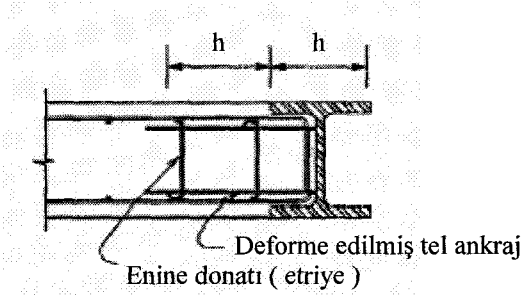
Betonarme veya kompozit kolon-çelik dışmerkezi çapraz bağlantısı [7]
